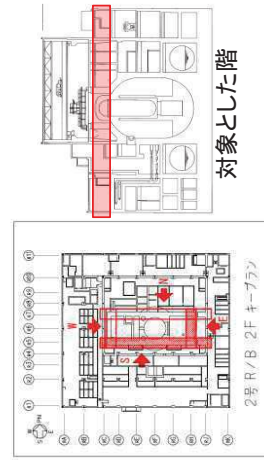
原子炉建屋のひび割れ分布 耐震壁 (46) 地上 2 階 RK 通り
